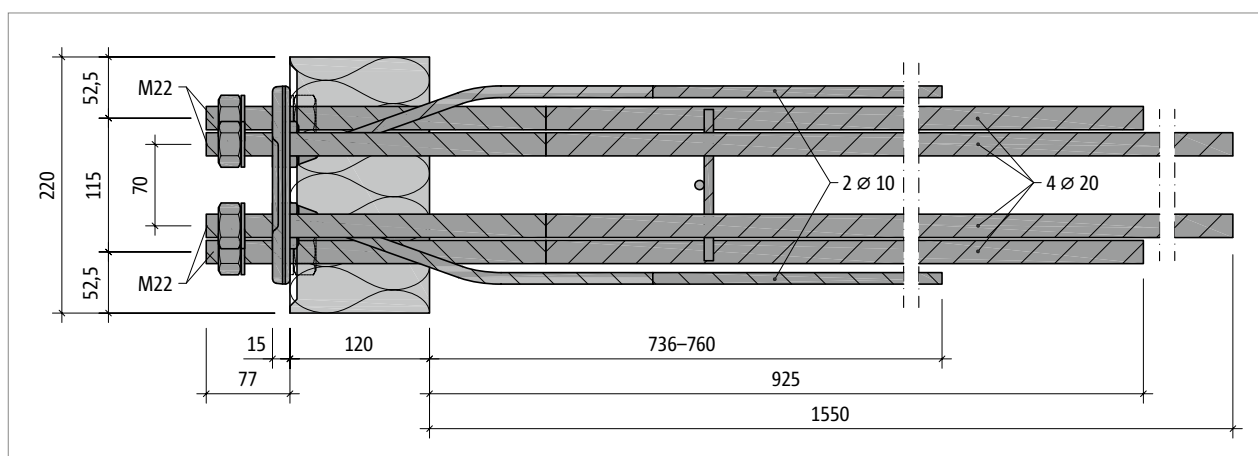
Schöck Isokorb® XT type SK-MM2-VV1 : vue en plan
